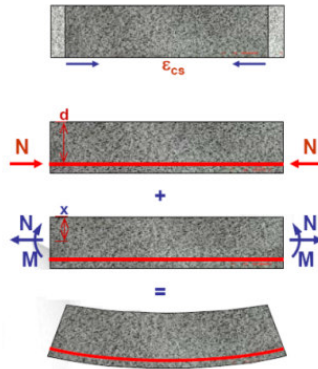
Efeito da retracção na deformação de uma viga de betão armado.
